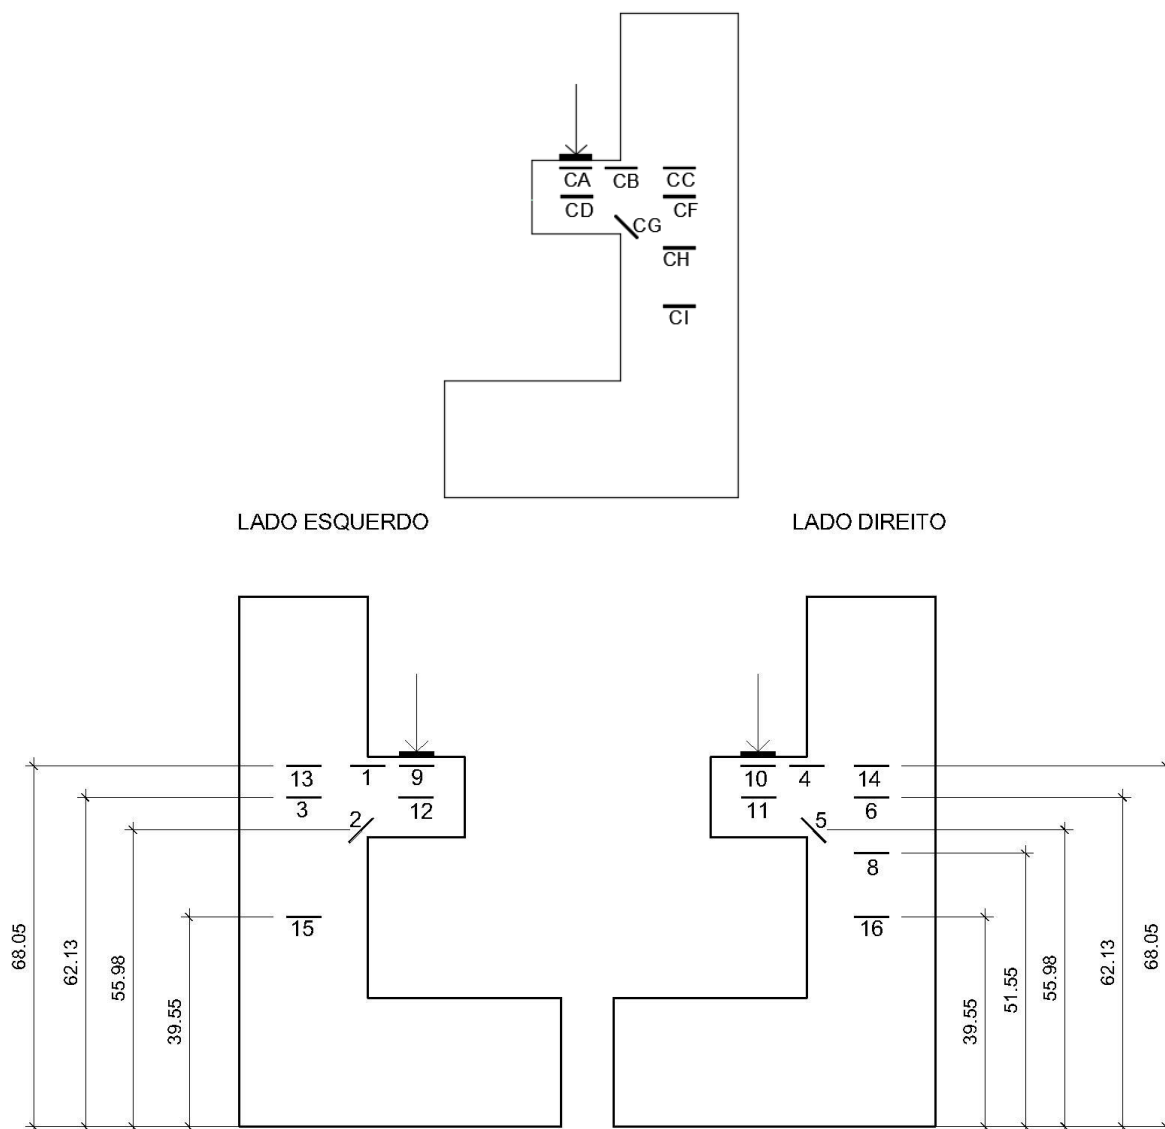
Extensômetros no concreto no modelo P1M1PC
